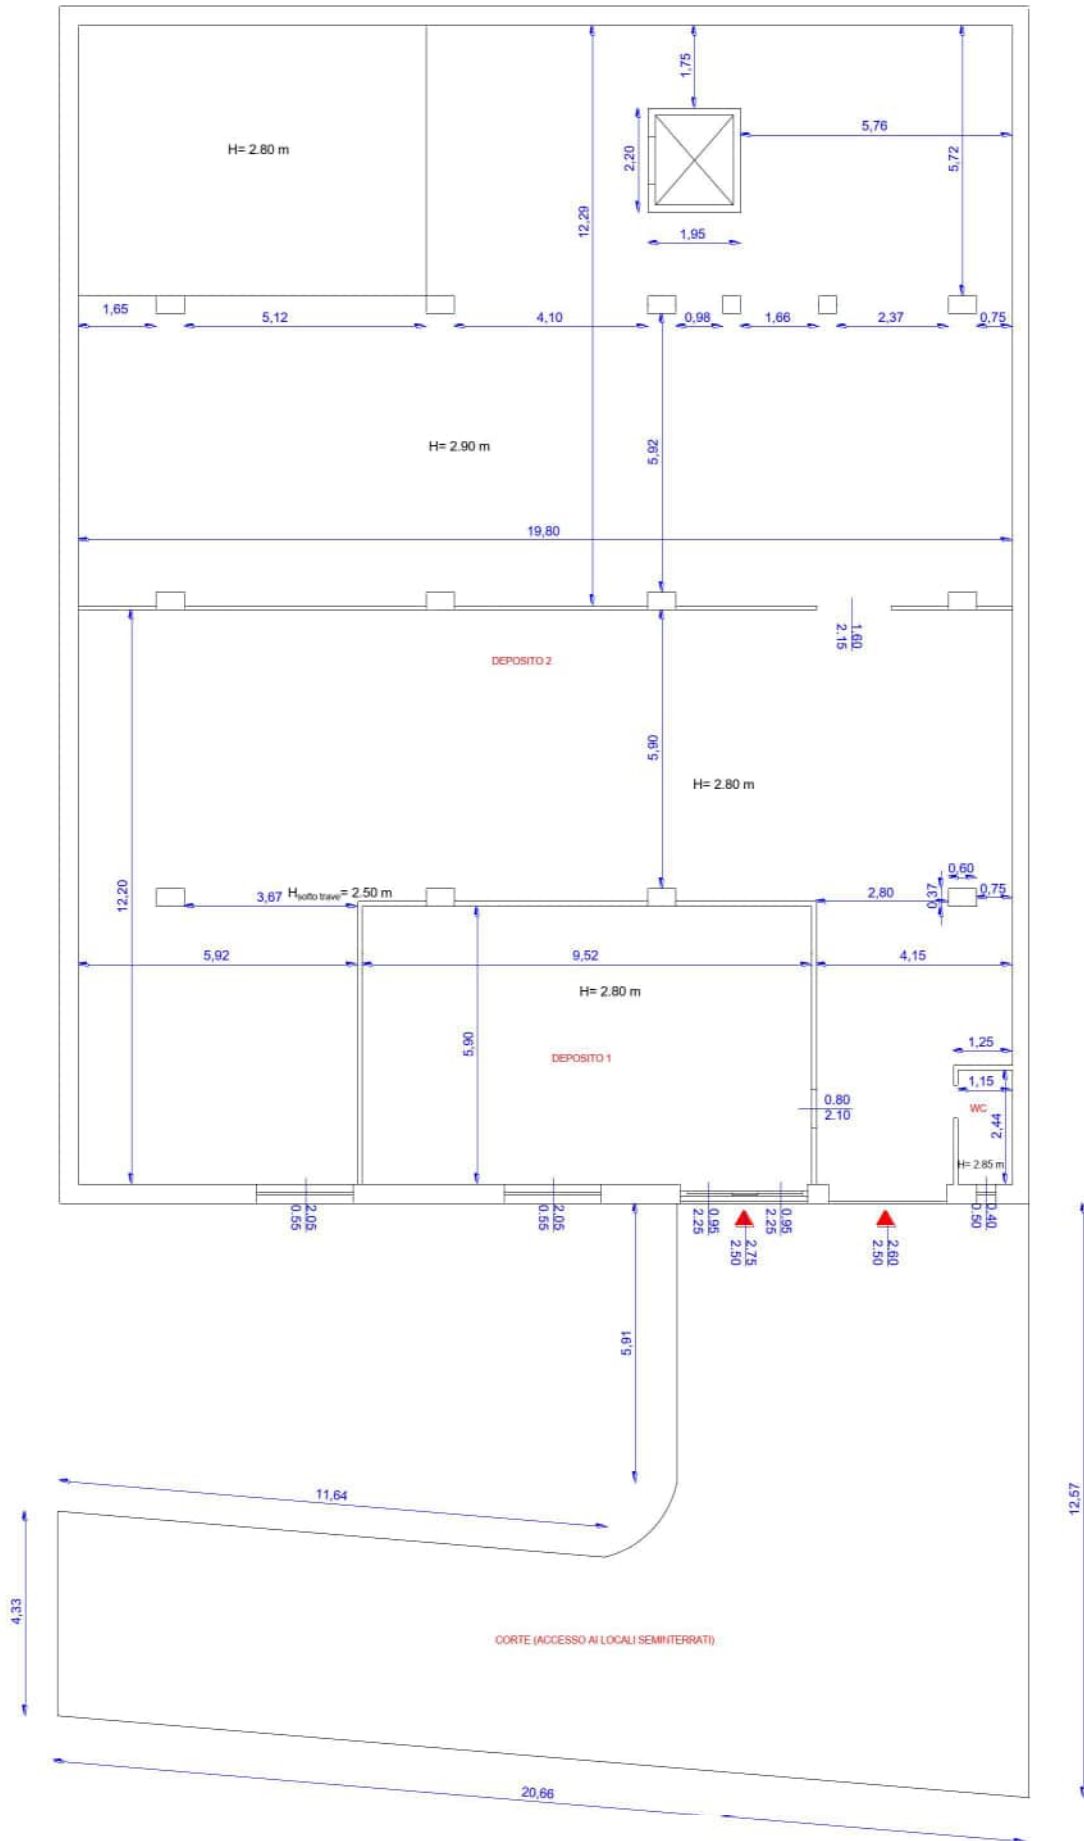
Planimetria da rilievo subalterno 29 – piano S2-T - particella 1016 – foglio 98 – Catanzaro
